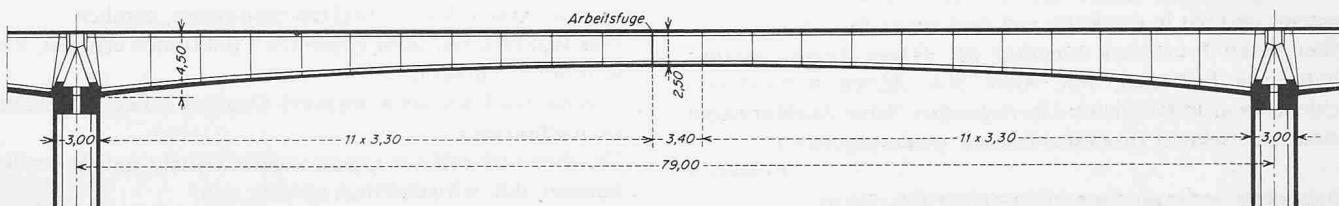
Brücke Oléron, Längsschnitt 1:500 eines Überbauteilstückes mit Pfeilerkopfausbildung
